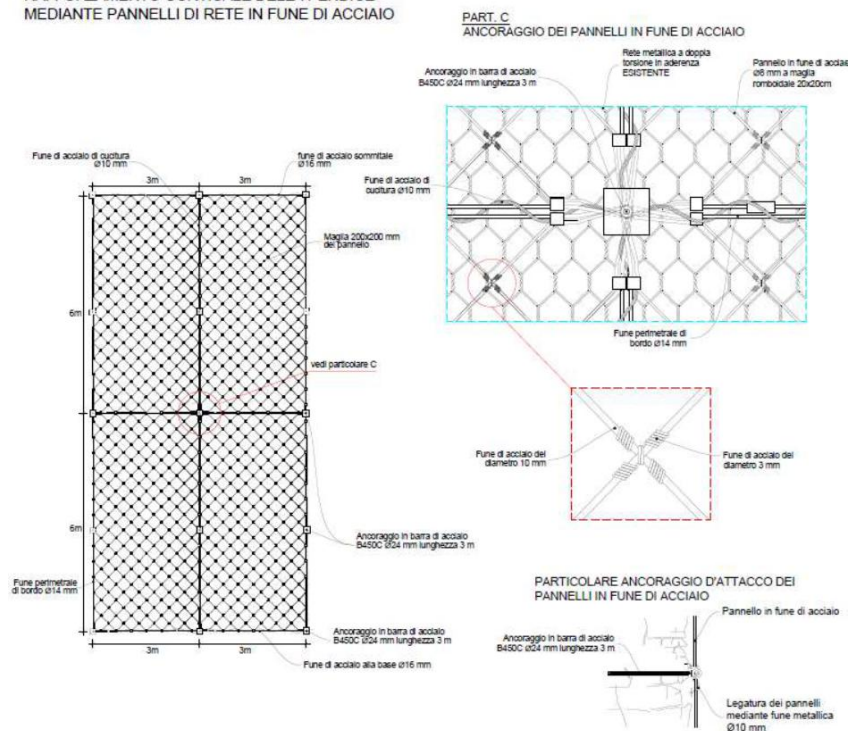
Sezione parziale rafforzamento corticale con particolare ancoraggio di attacco
